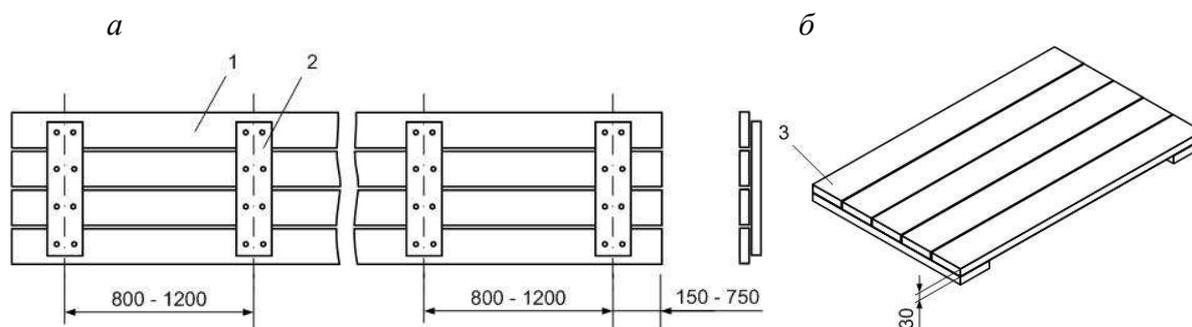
Мелкощитовая опалубка: *а* – щит на сшивных планках; *б* – клееный; 1 – опалубка; 2 – сшивная планка; 3 – торцовая обойма
